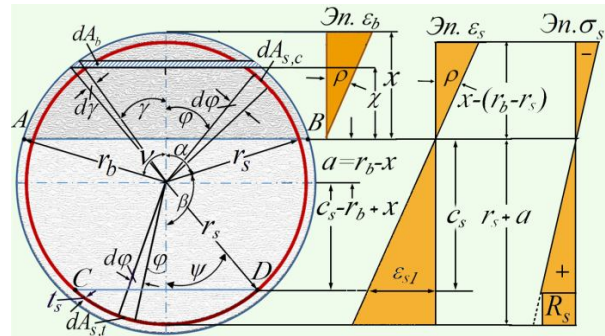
Напряжённое состояние расчётного сечения при упругопластической работе сжатого бетона и растянутой арматуры
